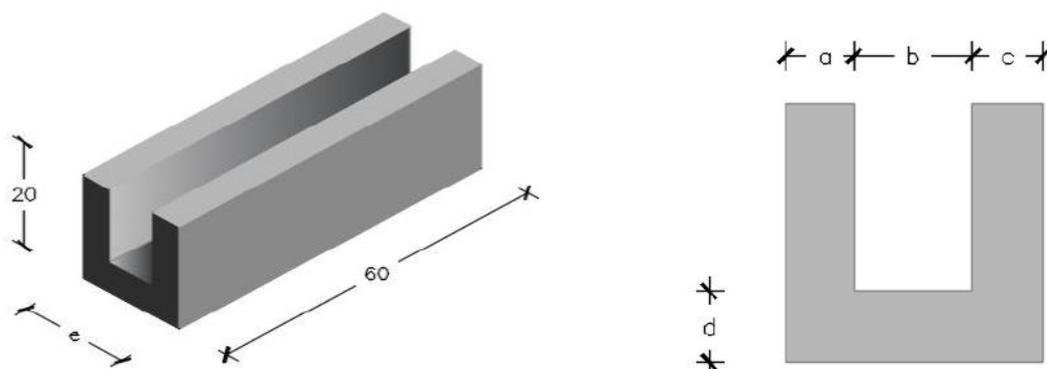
Block en “U” de Concreto Celular / Imagen de las fichas técnicas AICRET SMKT
